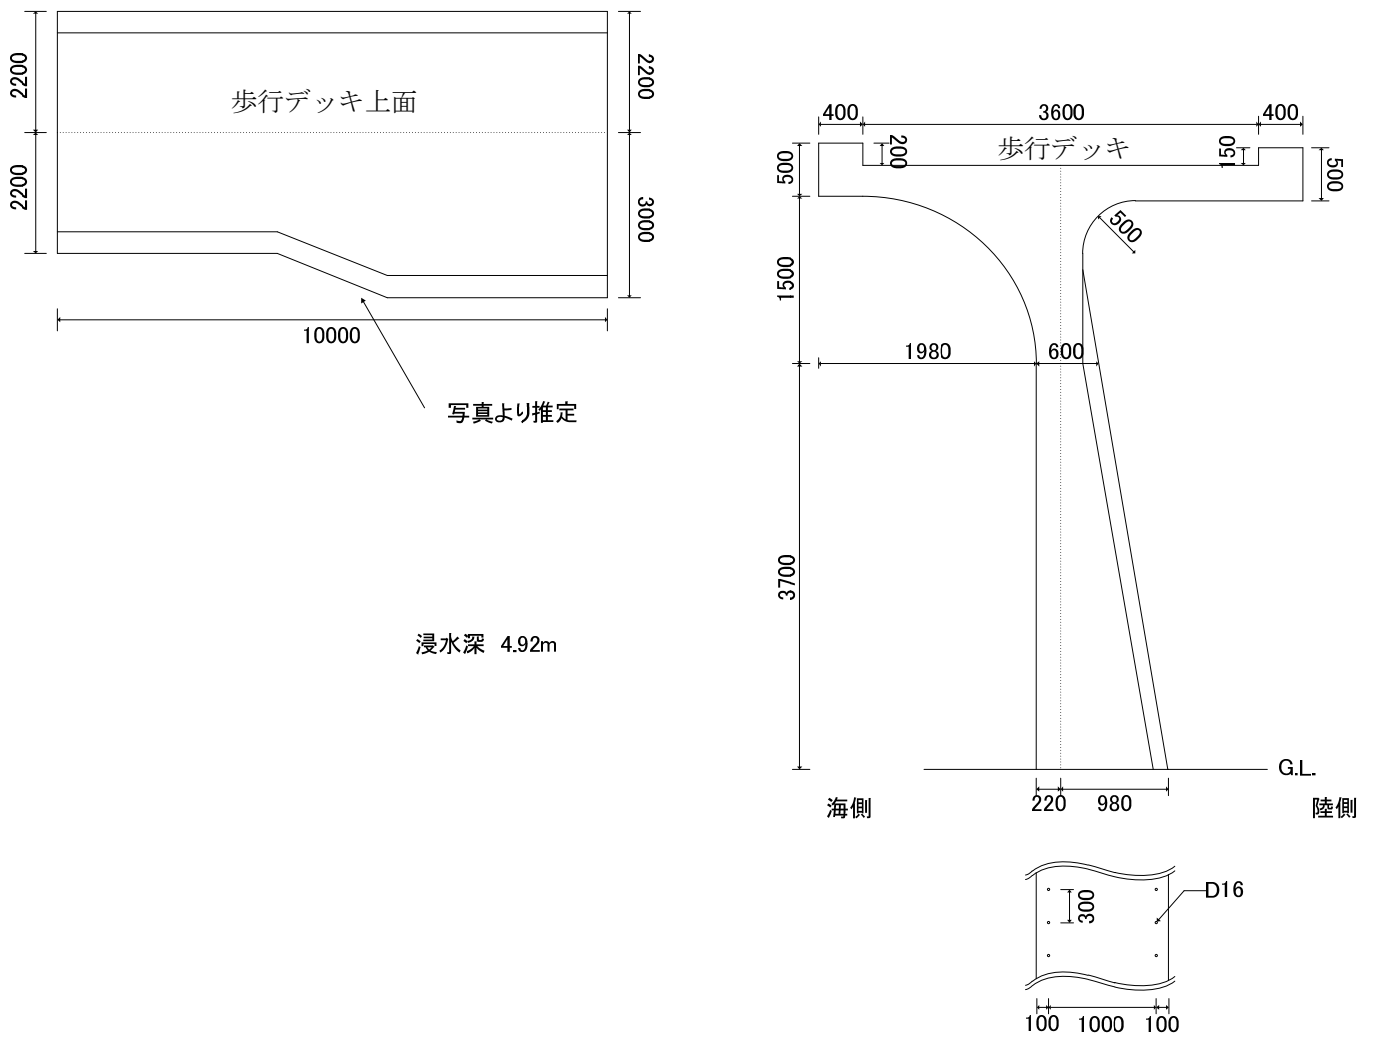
防潮堤の上面図・断面図・(単位: mm)
